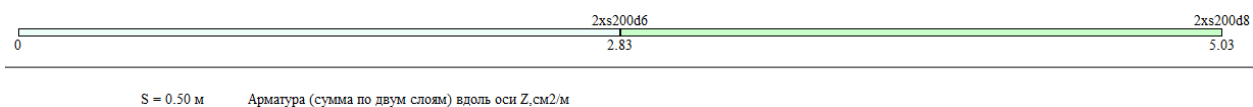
Карта необходимой площади вертикальной арматуры стены,
